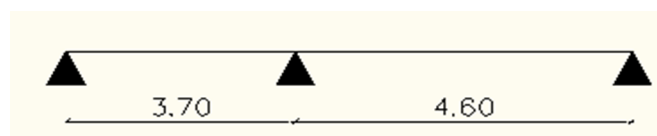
Schéma du 2^{ème} type de poutrelle.
